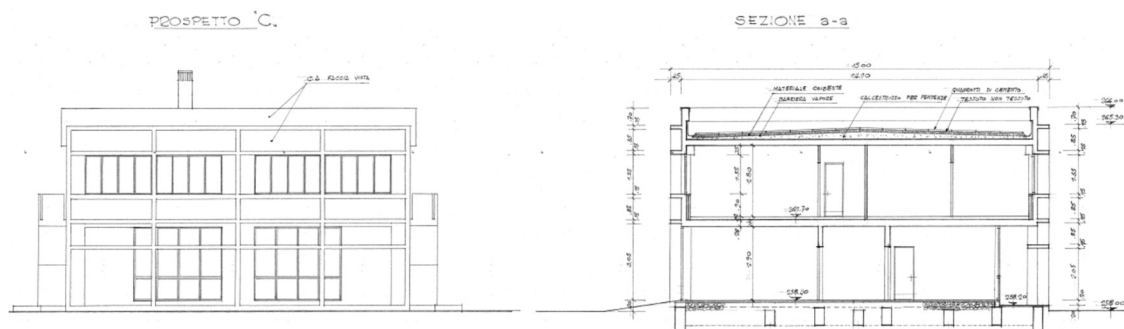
Progetto di esecutivo del 1985 – Prospetto e sezione
